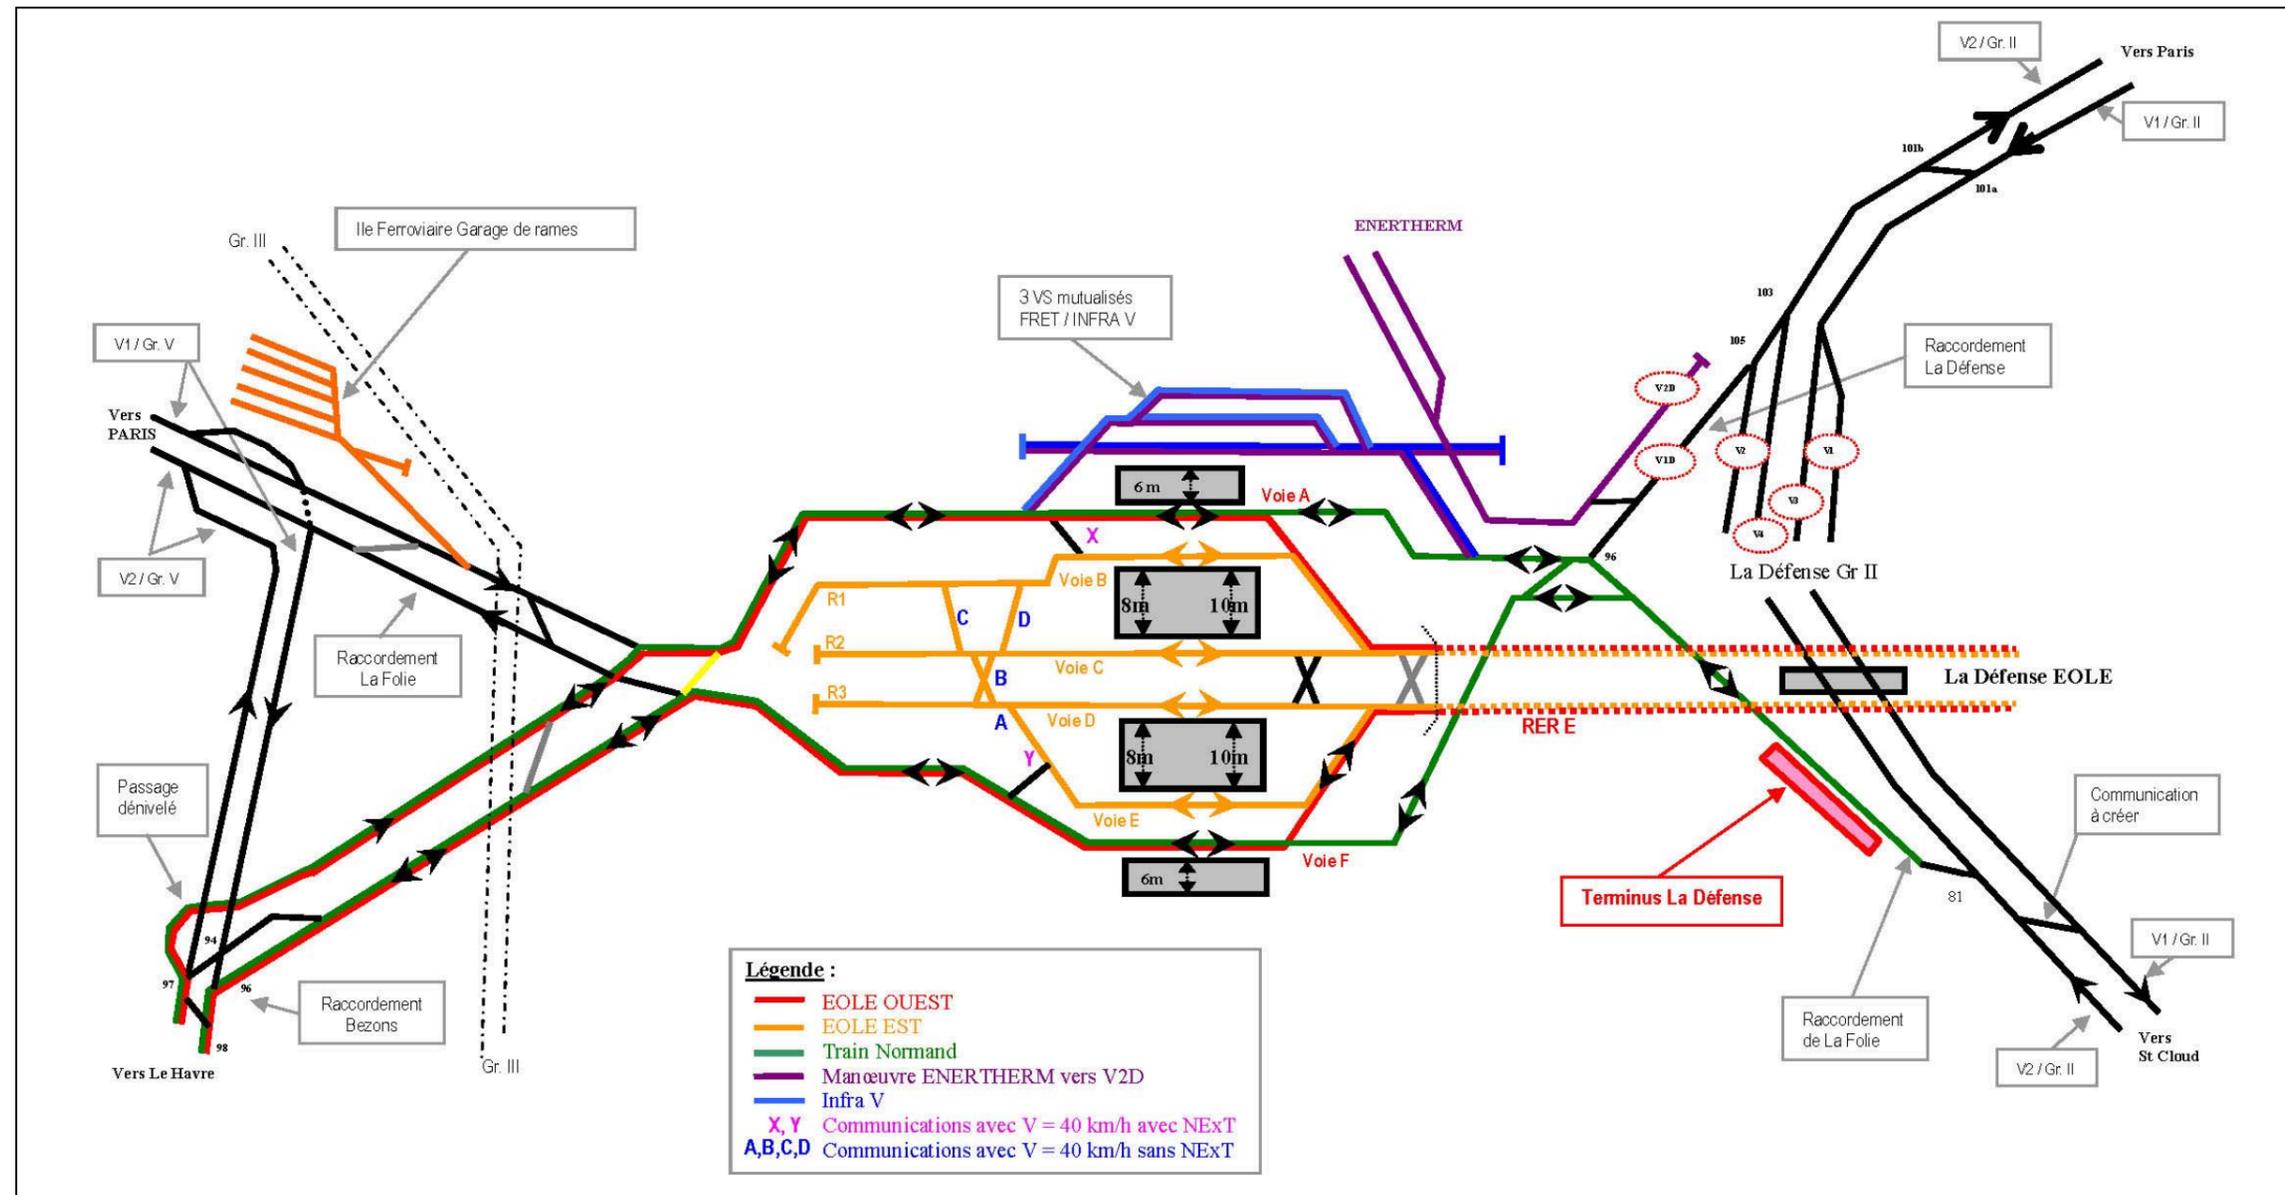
Plan schématique de l'aménagement du site ferroviaire de la
